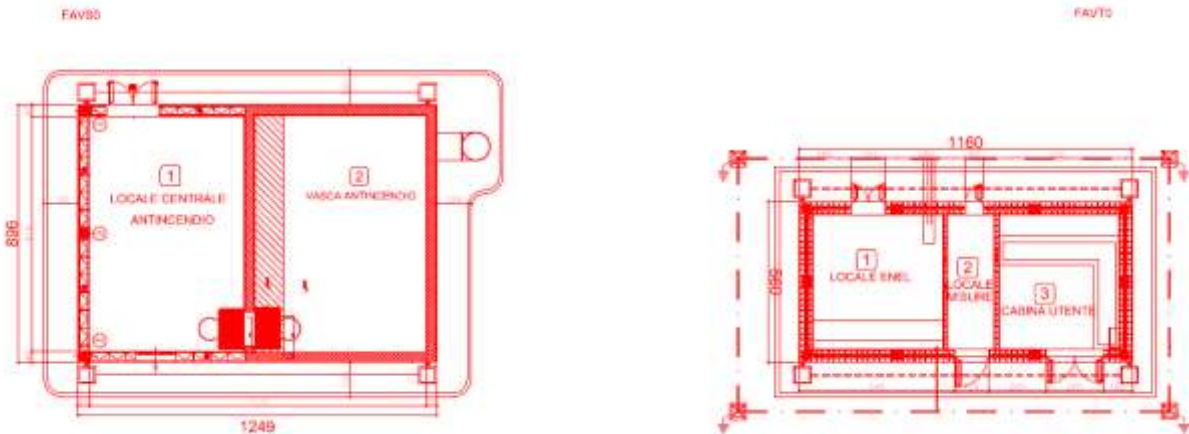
Pianta piano terra dei fabbricati nel Progetto di variante.
